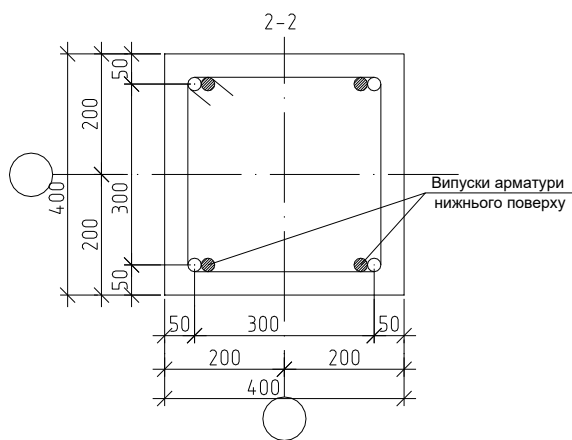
Схема армування колони К-2.2. Розріз 2-2.
